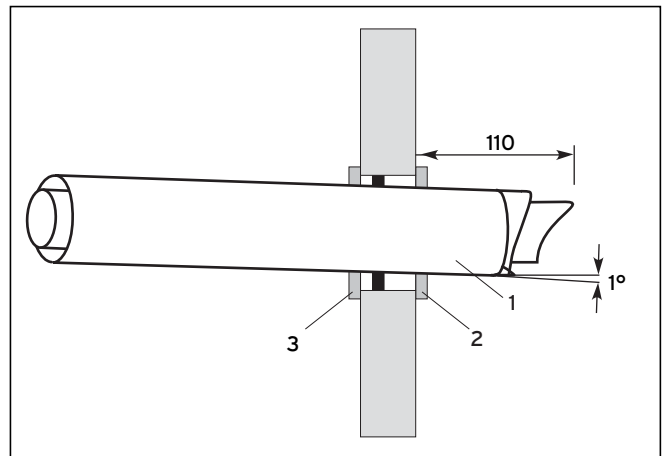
Montaggio del passante a parete (non si applica ad installazioni dirette)
